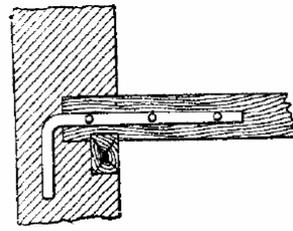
Ligação de apoio de pavimento-parede (adaptado de [4]).
